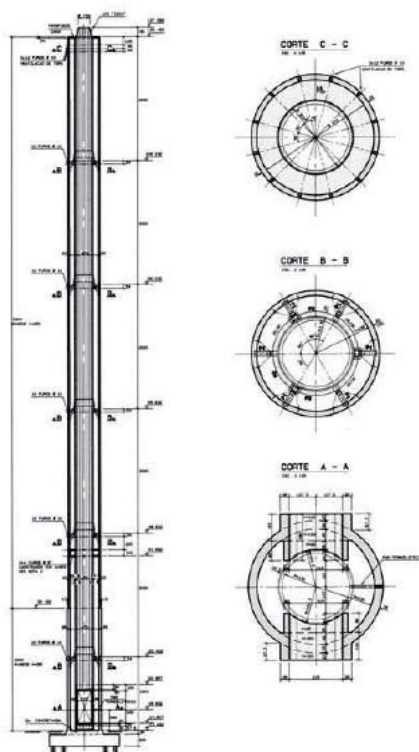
Chaminé de concreto armado - exemplo numérico.
